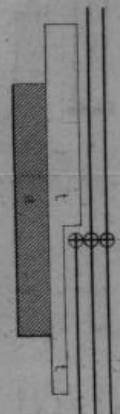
Grande Station à rebroussement — Stuttgart.
